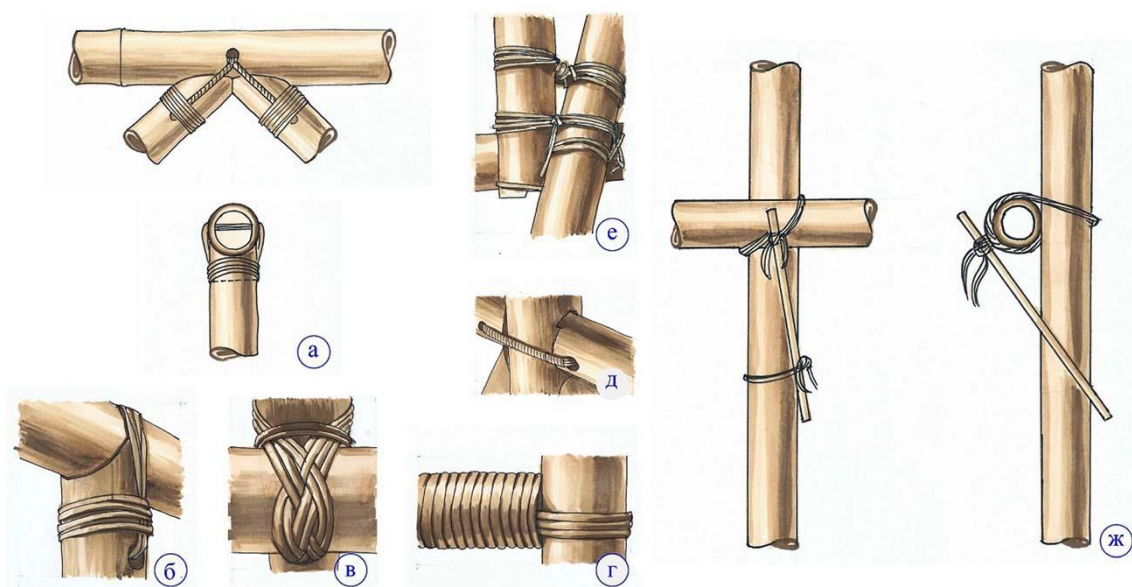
Примеры традиционного крепления конструктивных узлов: а) соединение верхнего пояса с двумя раскосами; б) соединение колонны и балки; в) плетеные ротанговыми полосами; г) плетеное соединение из сухожилий животных; д) ротанговое соединение через отверстия; е) тросовое соединение; ж) перпендикулярное соединение с помощью палки
